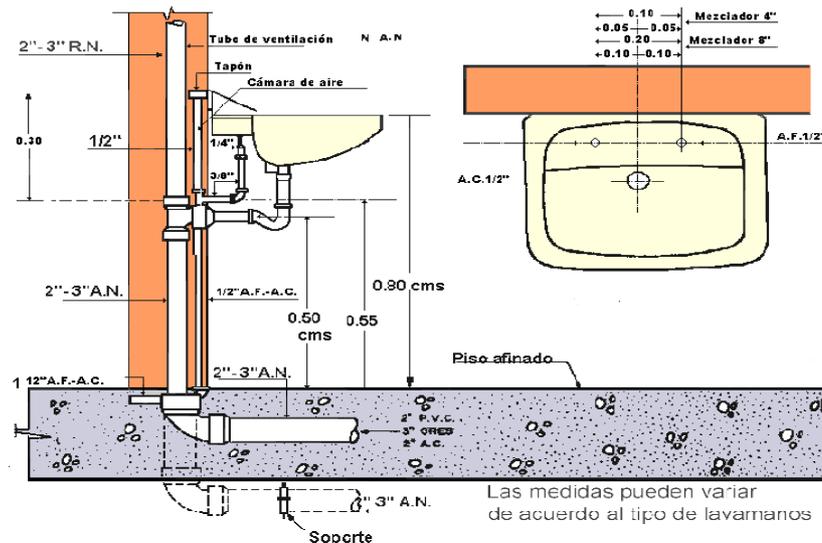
Plano detallado de la instalación de un lavamanos Fuente: Artes y Labores – SENA – Herald
